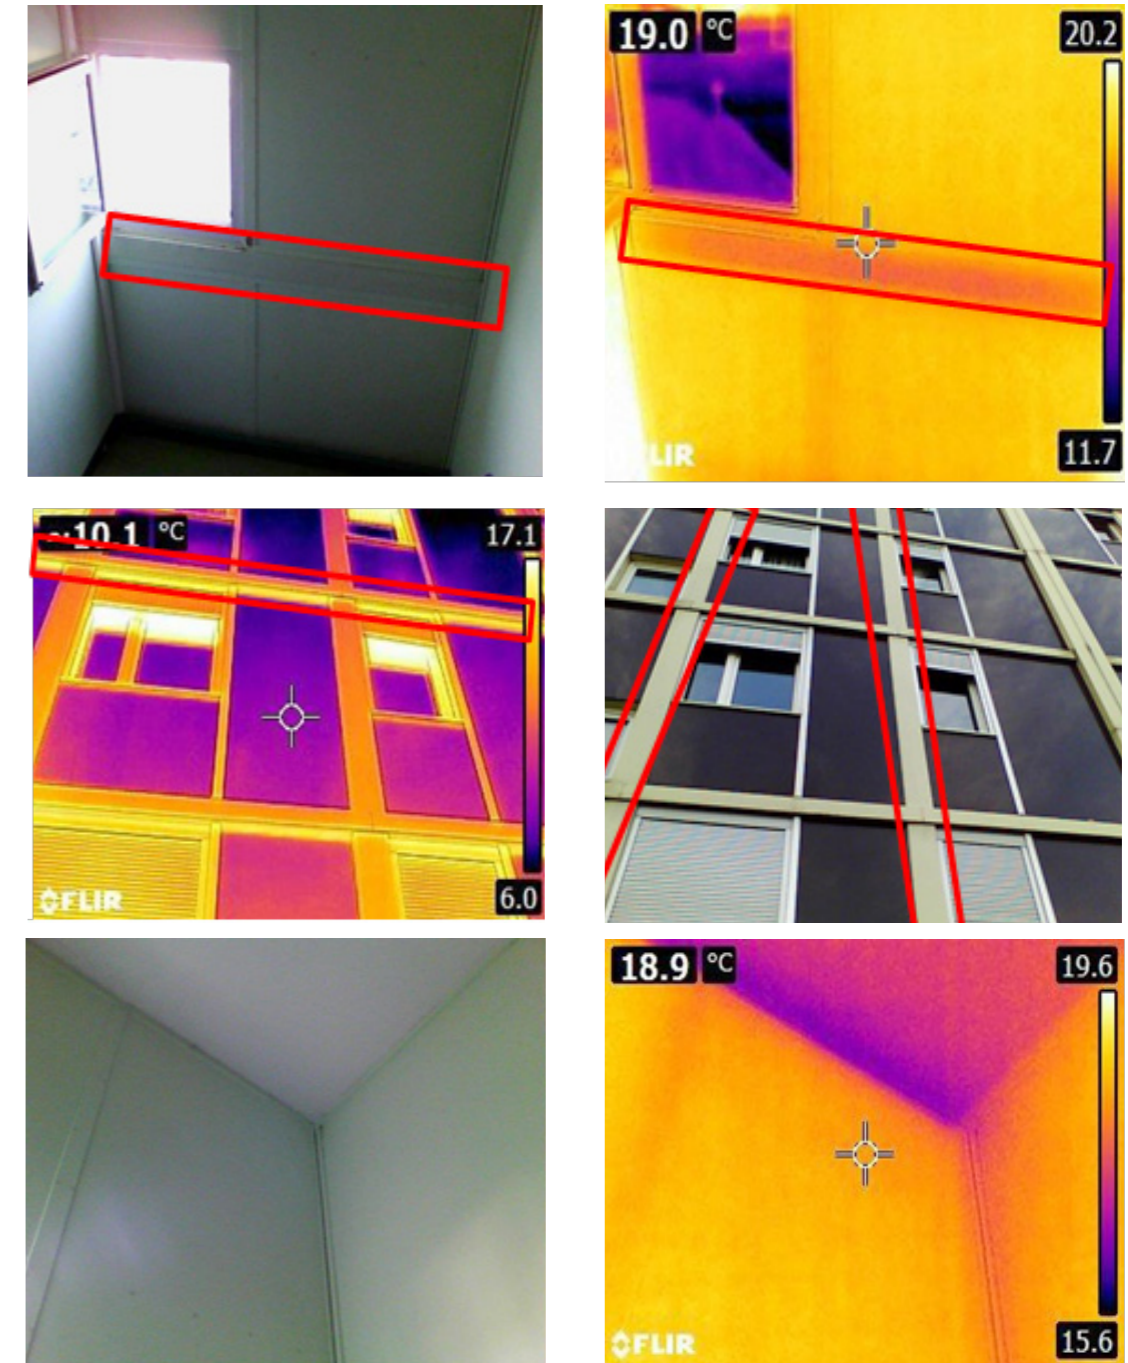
Ponts thermiques au niveau (1) du nez de dalle au niveau de la cage d'escalier (intérieur) – Plancher intermédiaire, (2) sur les abouts des murs de refend ou des joints de dilatation, et (3) de la liaison plancher haut – Façade rideau.
